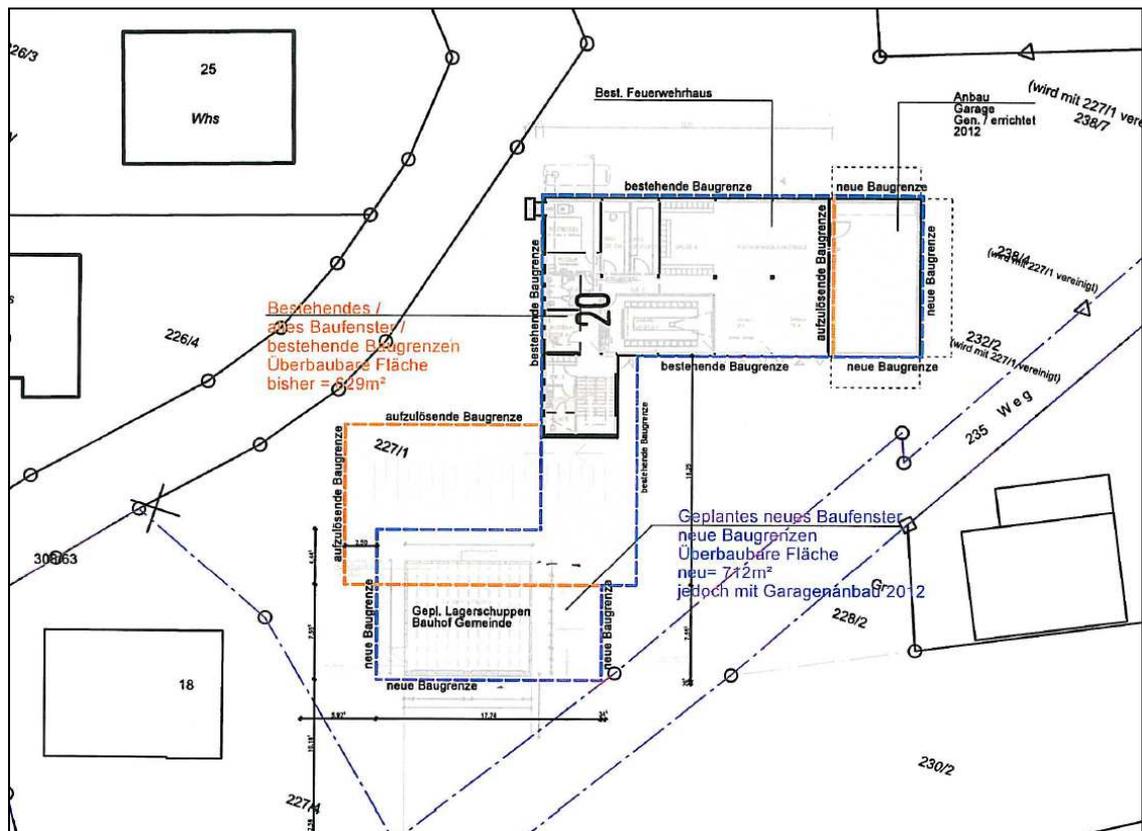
Verdeutlichung des Sachverhalts der 2. Änderung des Bebauungsplans „Blumenhalde“, Lageplanskizze von Wäschle Architekten 10/2018
